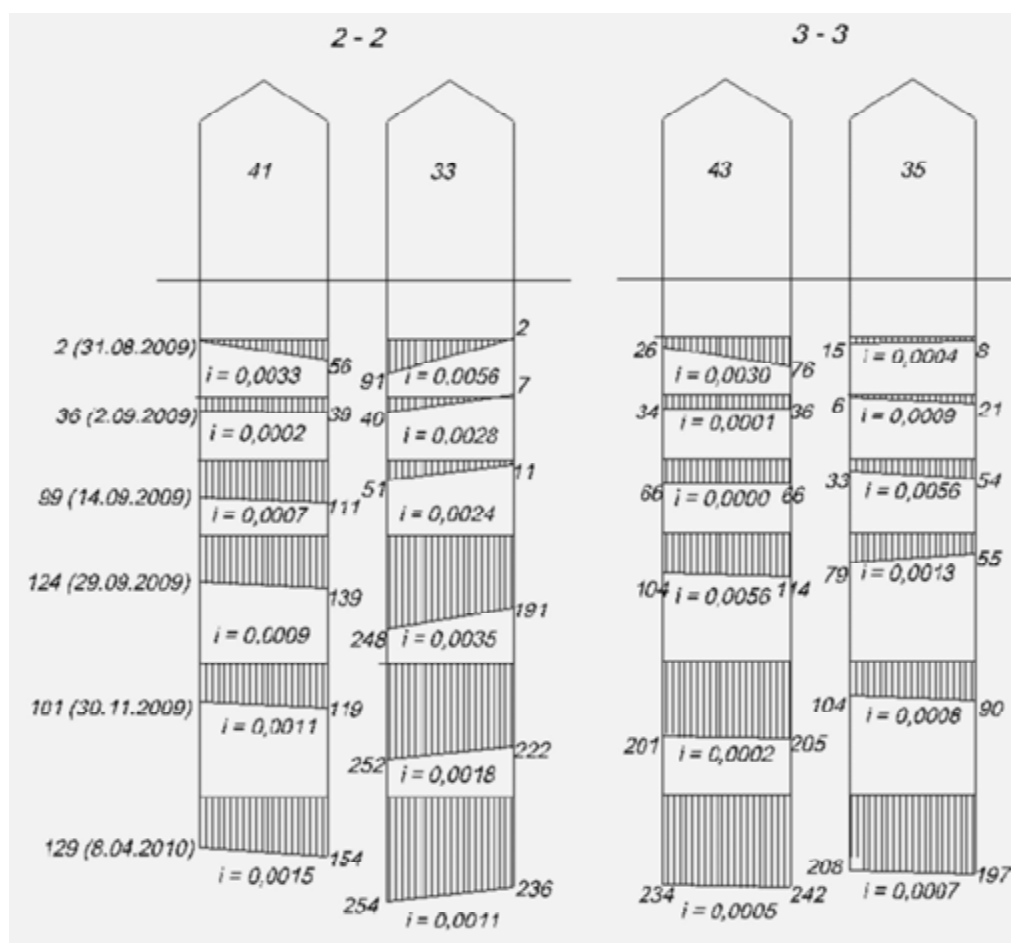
Эпюры осадок зернохранилищ СМВУ 165.18.В12 №41 – №33 и №43 – №35 в поперечном направлении, мм; i – крен фундамента
